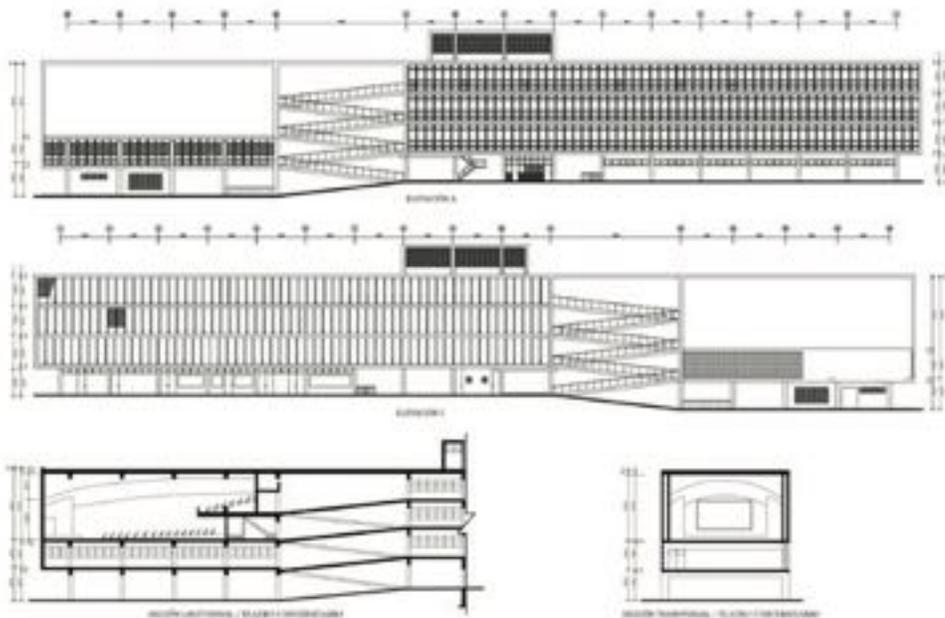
Vistas de las fachadas principal y posterior, y secciones del teatro. Fuentes: J. Izquierdo (2013), J. Drago y J. Sánchez (2024).
